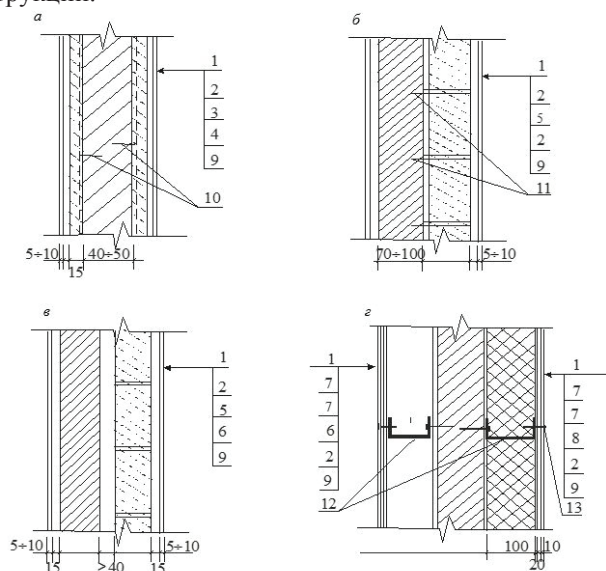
Конструктивные решения по повышению звукоизоляции ограждений: а, б – увеличение поверхностной плотности; в – устройство дополнительной перегородки; г – гибкие плиты на отnose; 1 – отделочный слой; 2 – штукатурка; 3 – торкретбетон; 4 – стальная сетка; 5 – пазогребневые плиты; 6 – воздушный промежуток; 7 – обшивочные листы (ГВЛ, ГКЛ, ОСП); 8 – звукопоглощающий материал; 9 – существующая перегородка; 10 – дюбель-гвоздь; 11 – анкерный дюбель; 12 – стальной гнутый профиль; 13 – саморез
